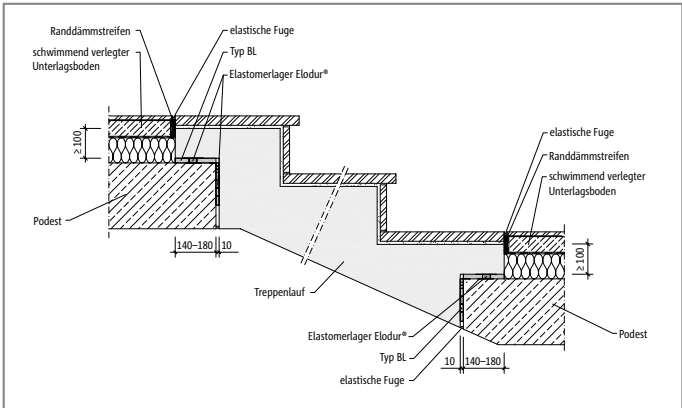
Schöck Tronsole® Typ BL: Einbausschnitt
